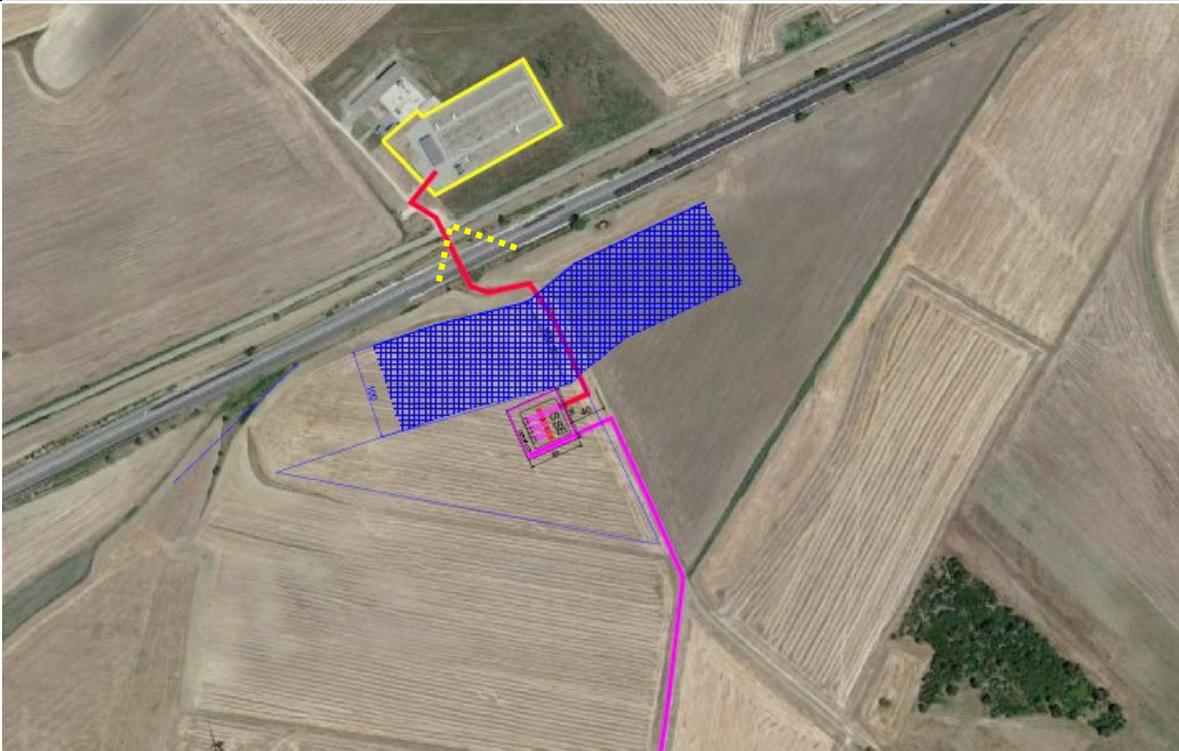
Layout di impianto dell’Area della Sottostazione Utente
